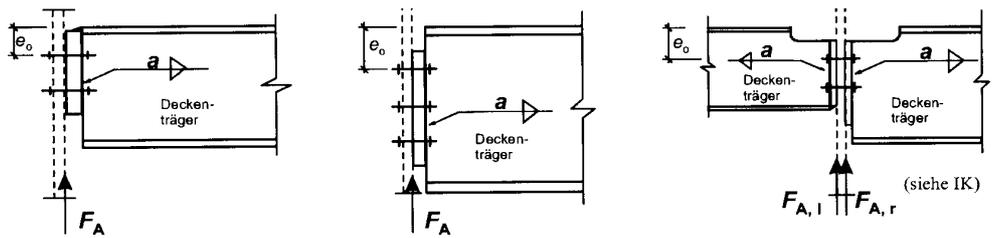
Mögliche Trägeranschlüsse mit gelenkigen Stirnplatten
